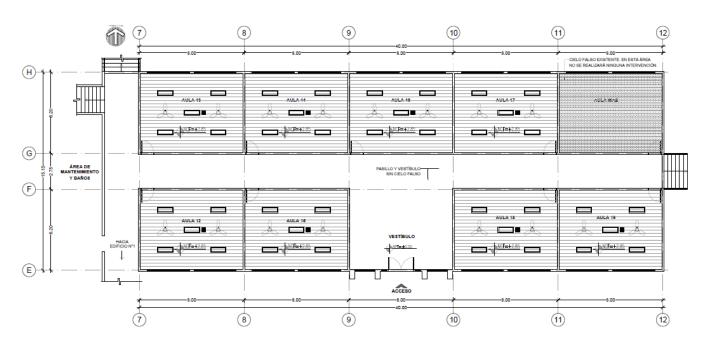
Planta de cielos reflejados y ventiladores en Edificio N°2
